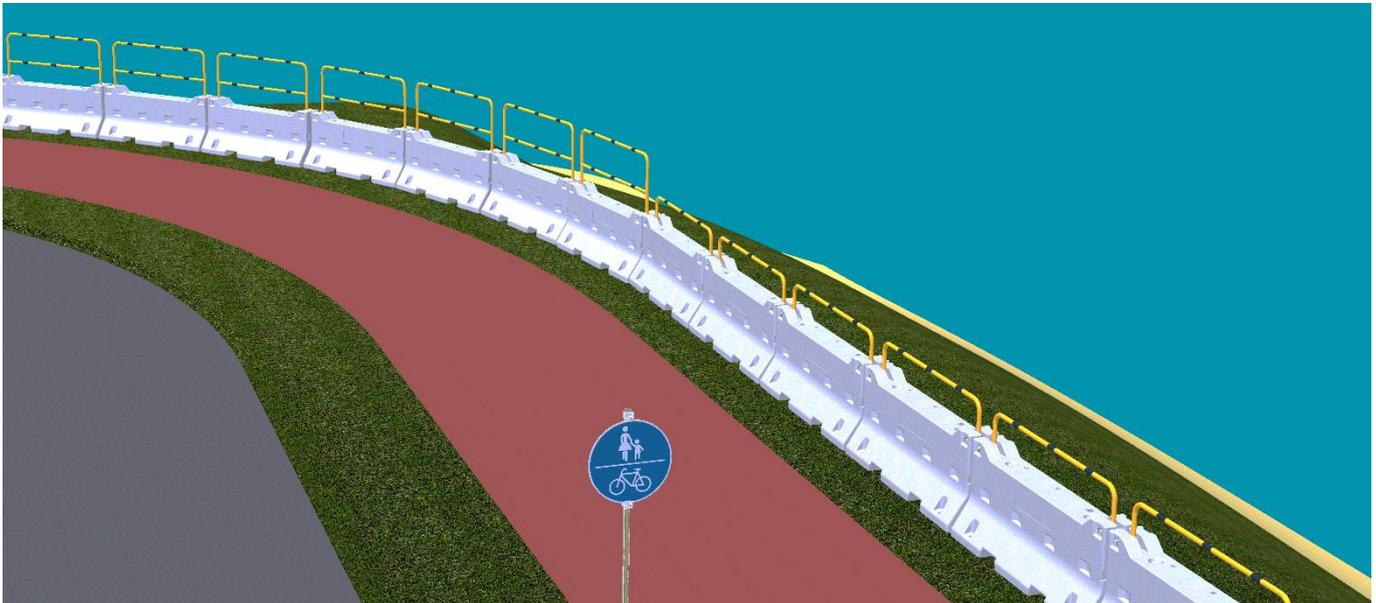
Betonelemente mit Bauzaun 3B2023 als Umzäunung und Absturzsicherung mit erhöhter Durchbruchssicherheit gegenüber Fahrzeugen an einer Baustelle
